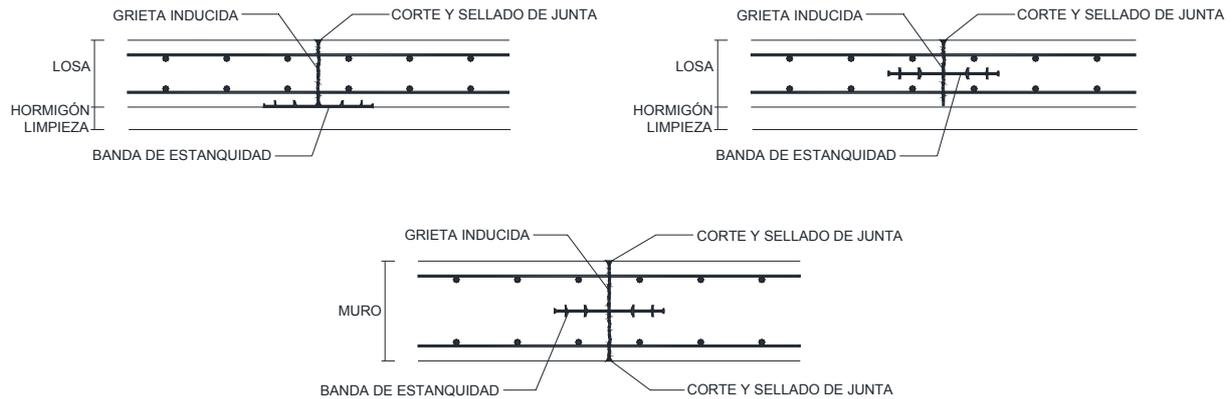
Detalle de junta de retracción en solera (arriba) y en muro (abajo)
